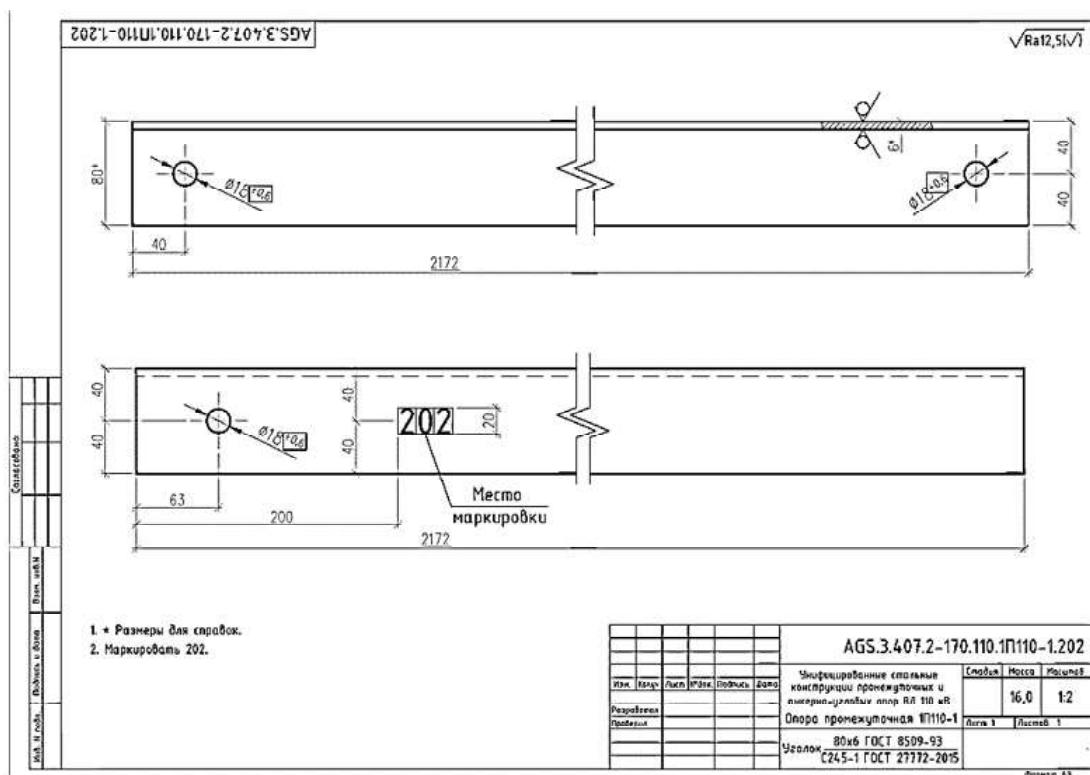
Рабочий чертеж раскоса разработанный с использованием системы ЕСКД.
